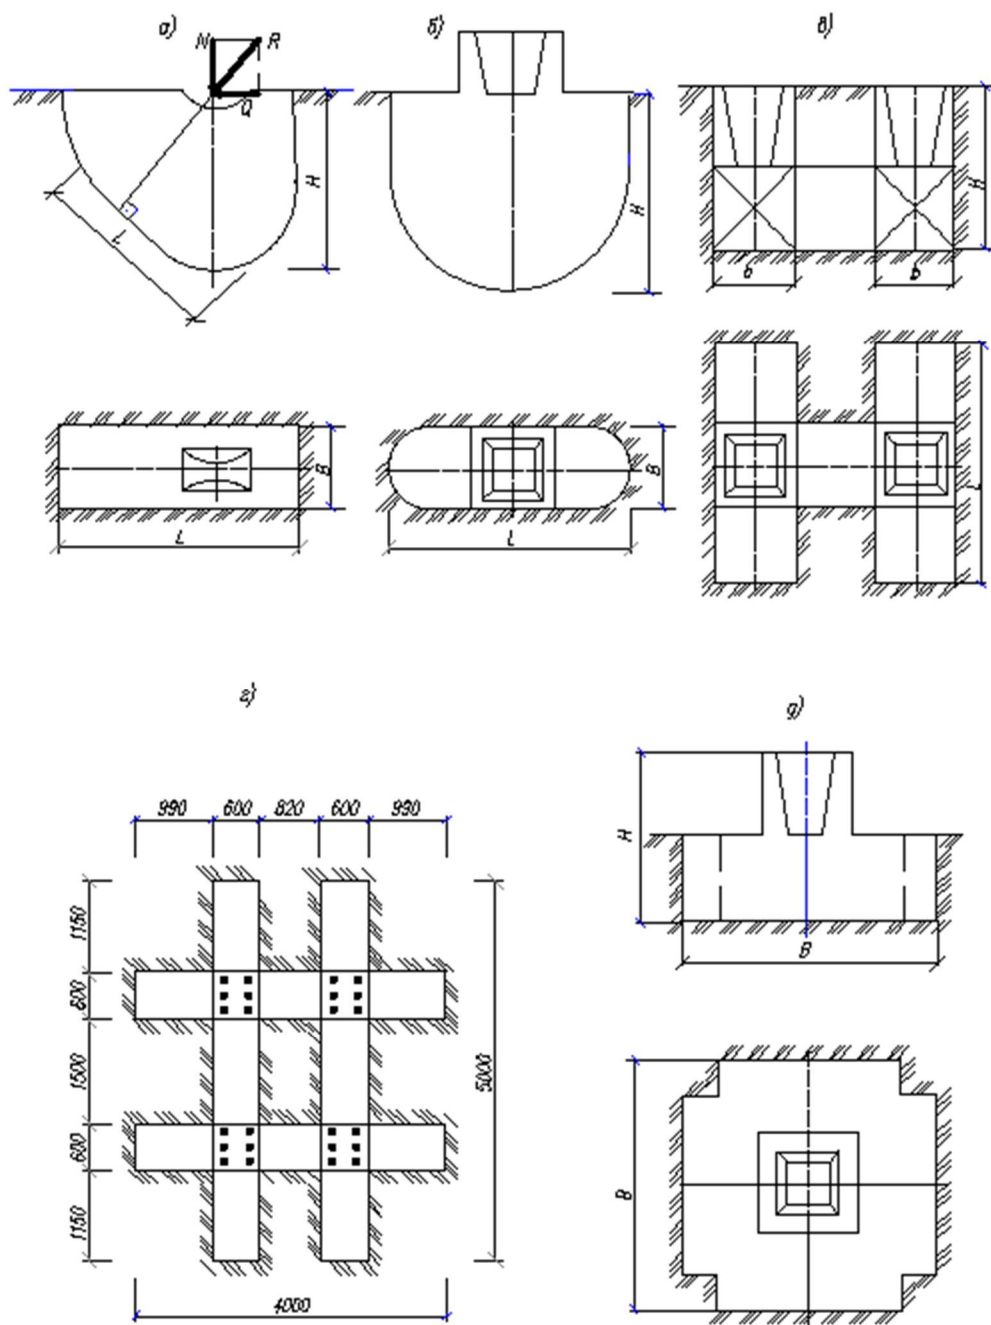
Эффективные конструкции фундаментов неглубокого заложения с рабочей боковой поверхностью: *a* – шлицевой фундамент под трёхшарнирную раму; *б* – то же под железобетонную колонну; *в* – траншейный фундамент двугавровой формы; *г* – траншейный фундамент под осветительную мачту; *д* – одноплитный под железобетонную колонну
